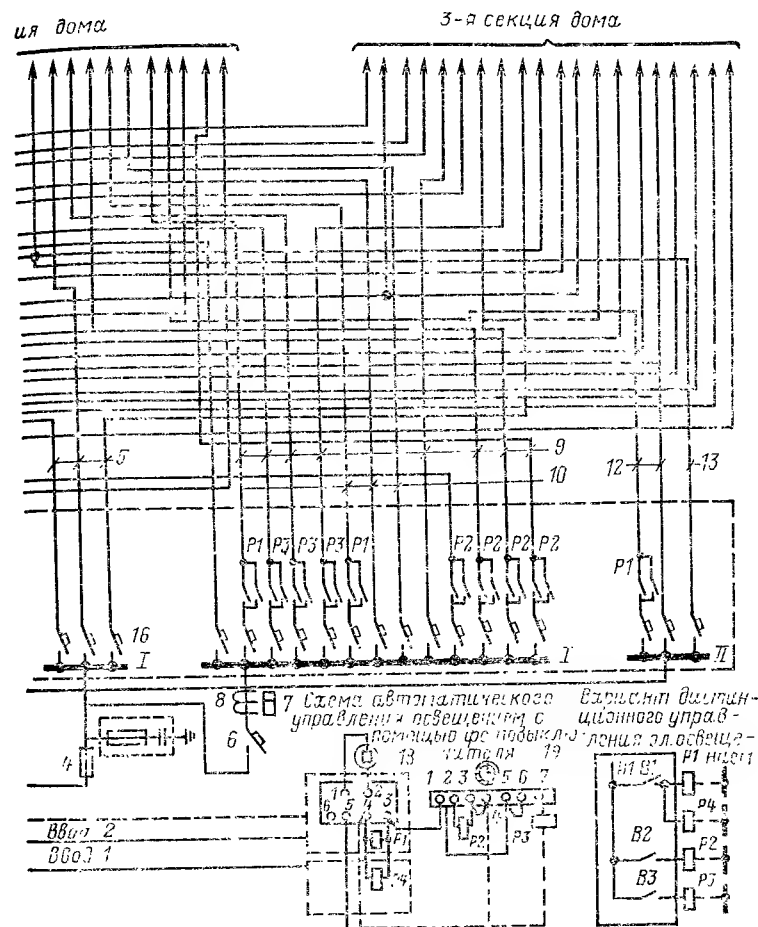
Схема электрооборудования 16-этажного жилого дома
